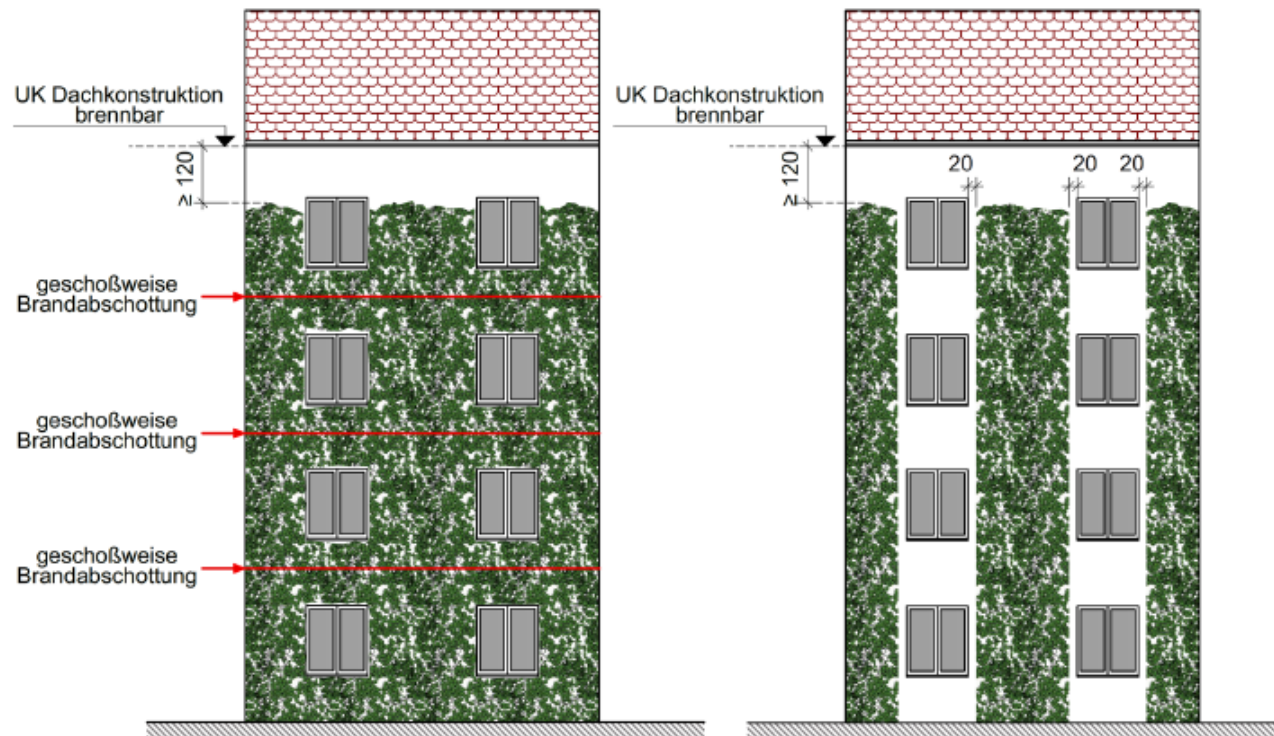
zu Punkt 3.5.13 Fassadenbegrünung – Maßnahmen bei Gebäuden der GK 4 und GK 5 mit Steildach
